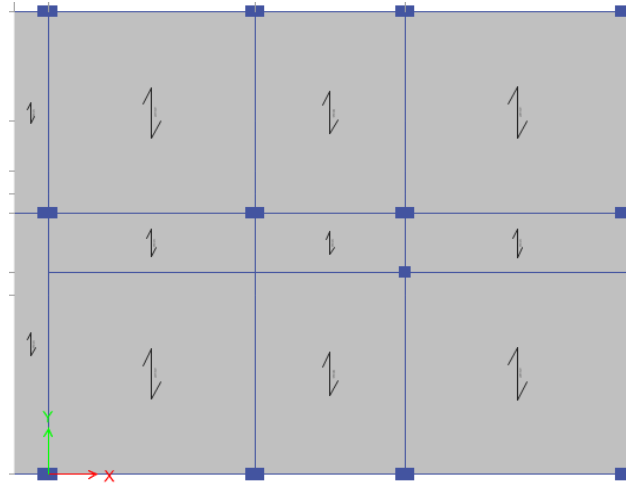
Asignación columnas, vigas y losas – módulo 1.
